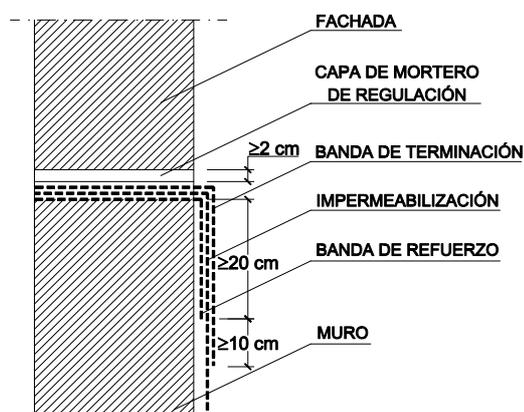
Ejemplo de encuentro de un muro con una fachada
